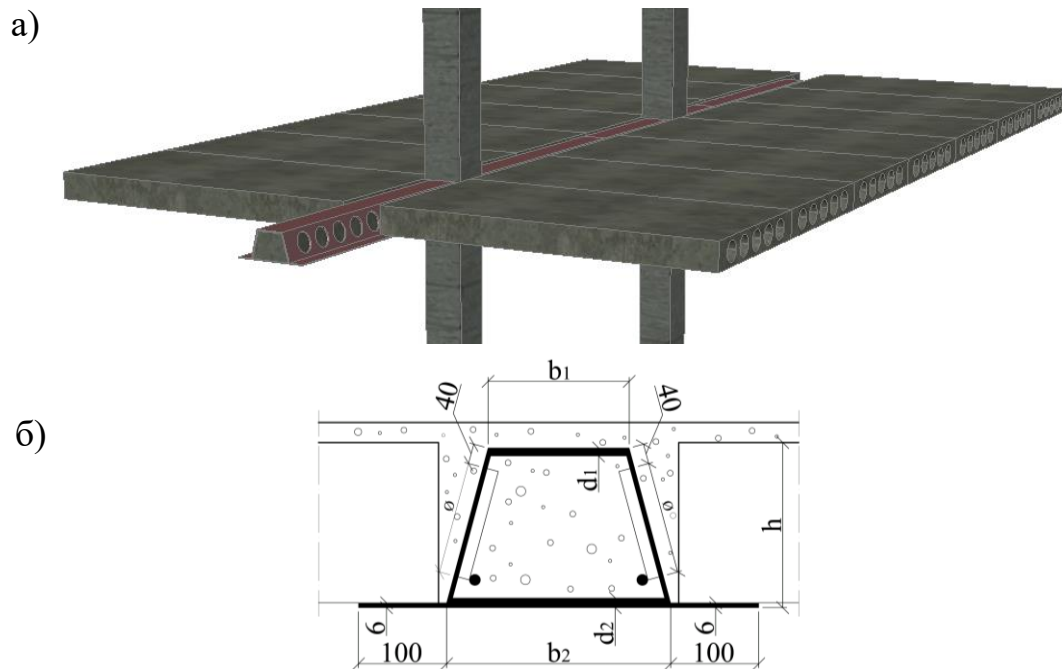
Збірно-монолітний каркас "Delta" зі сталезалізобетонним ригелем
